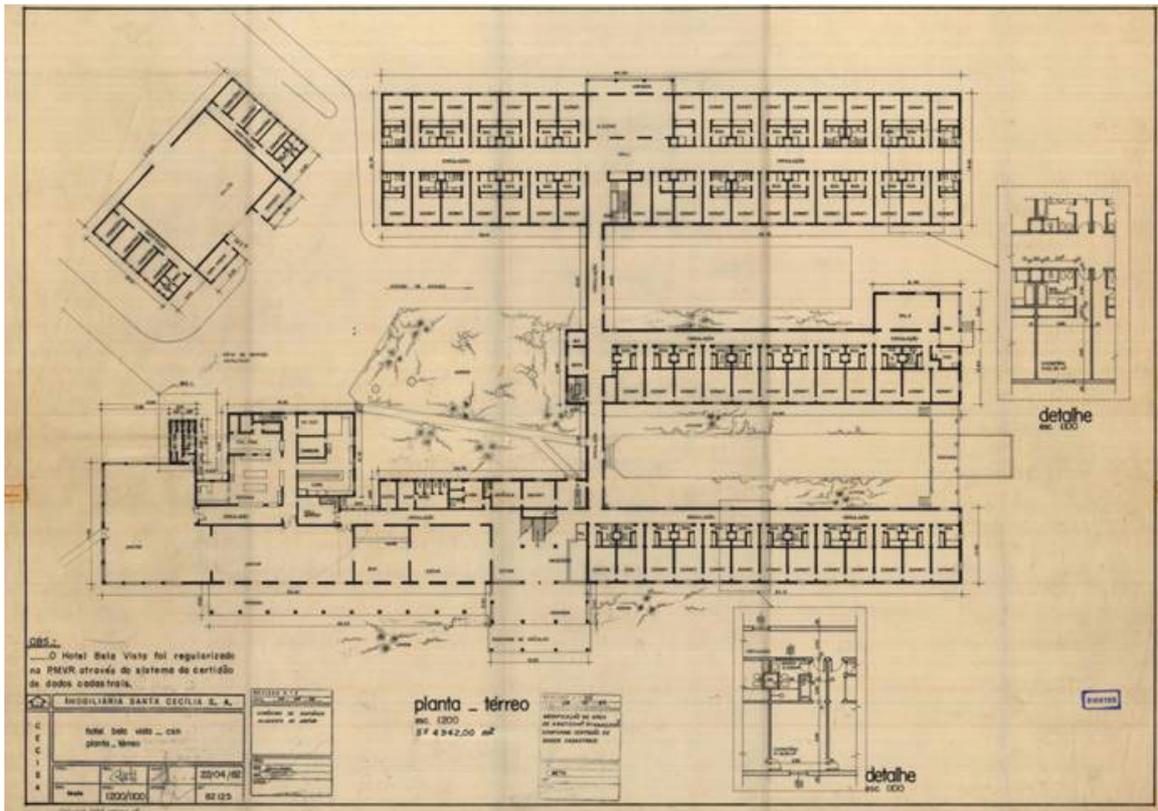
Projeto Construtivo – Pavimento Térreo (1982).
